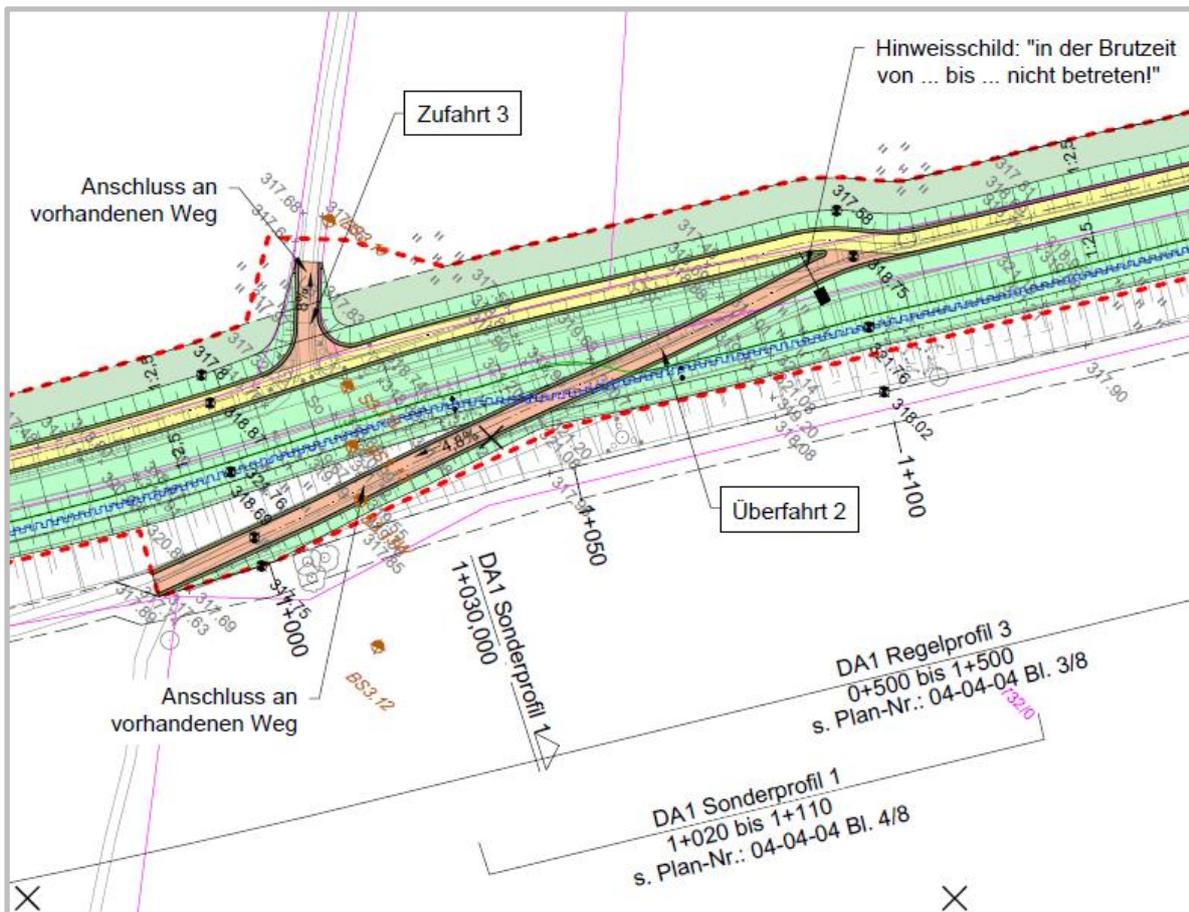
Vorhandene und zukünftige Wegeverbindungen im Bereich des Einlaufbauwerkes auf der Grundlage des Lageplanausschnittes gemäß Plan-Nr. 03-03-01, Blatt-Nr. 1/1
